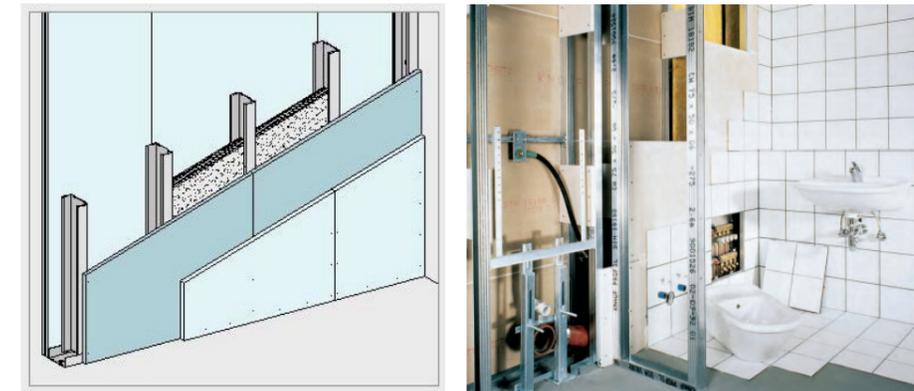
Detalle tabiquería KNAUF doble (Web Knauf)
